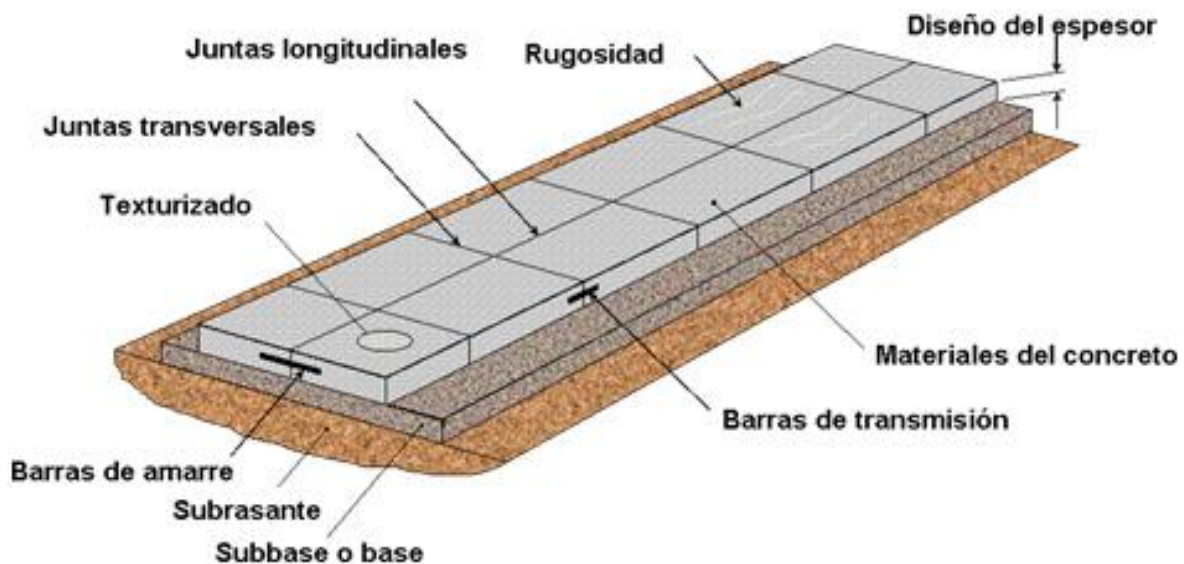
Juntas Transversales y Longitudinales en el Pavimento Rígido.
